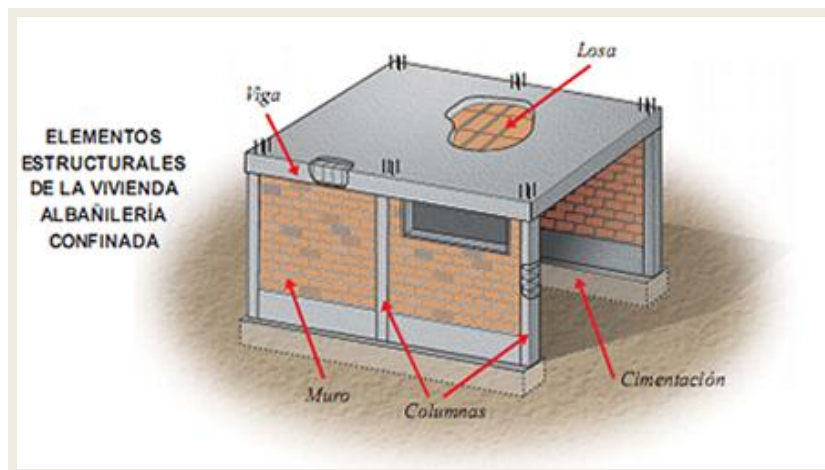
Muro de albañilería confinado por elementos de concreto armado.
